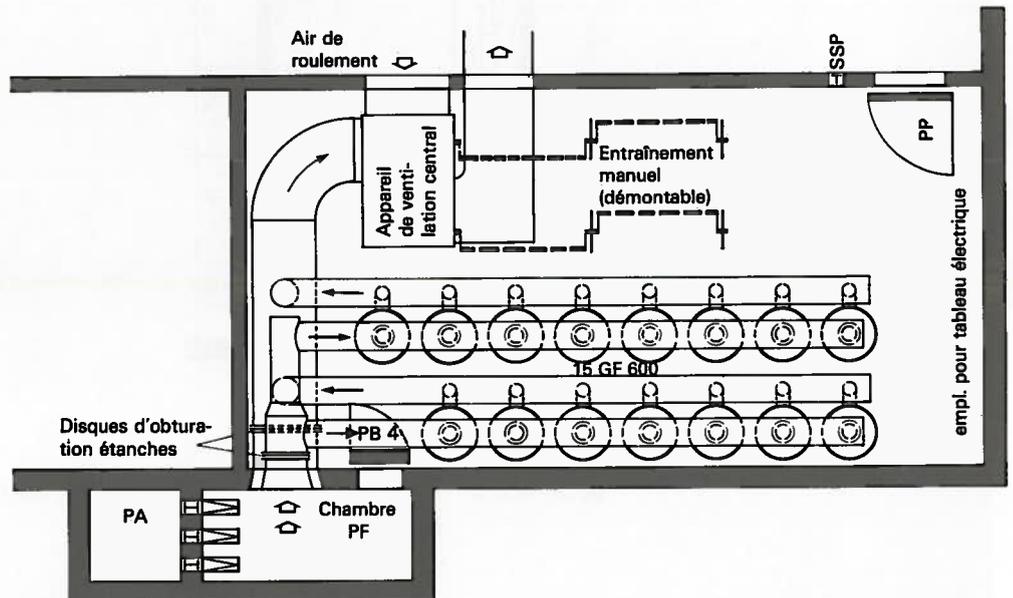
Exemple d'un local de ventilation avec appareil de ventilation central et 15 GF 600 (plan)
